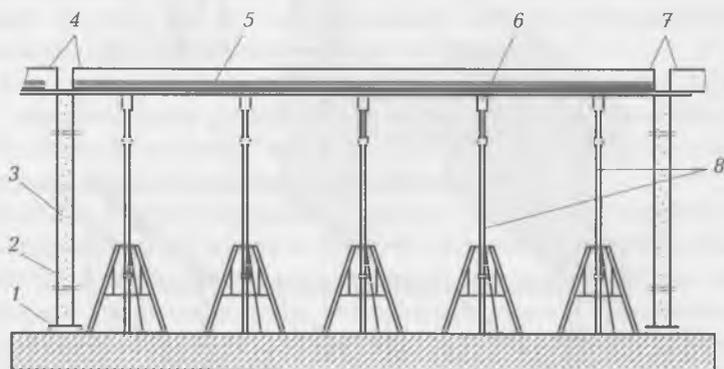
Опалубка балочного перекрытия (разборно-переставная):
